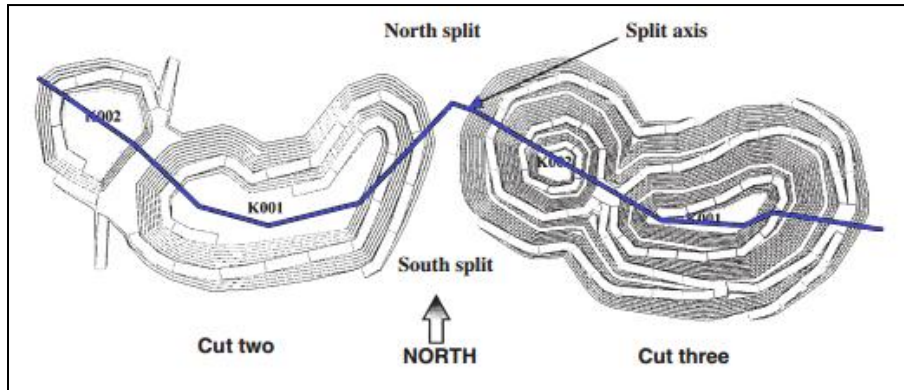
DISEÑO TRADICIONAL DE LOS CORTES 2 Y 3
